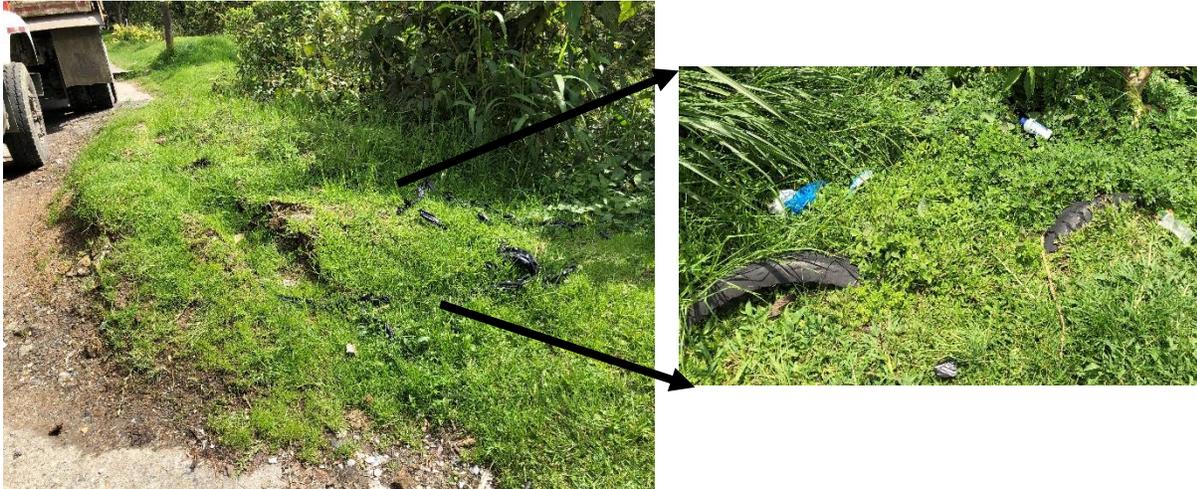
Grietas de tensión y basuras en el K0+100
